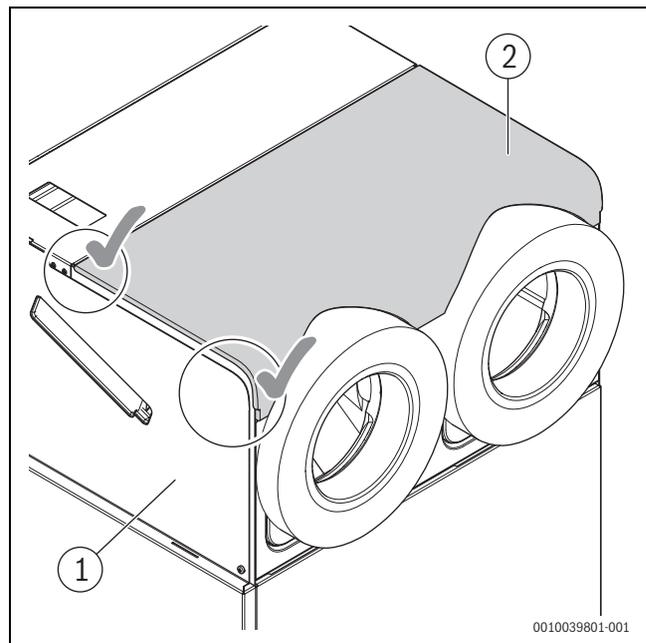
Finaler Zustand - Anschlussstutzen seitlich
